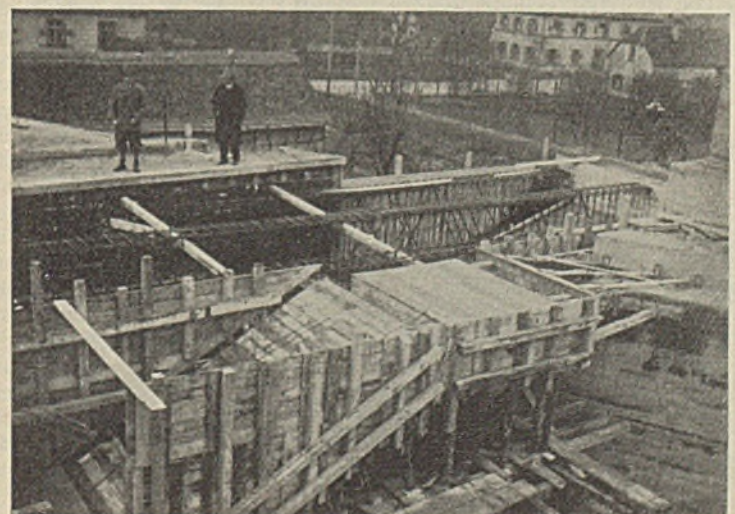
Östlicher Teil der Bewehrung der Eisenbetonträger und Schalung für Treppe und Podest.
